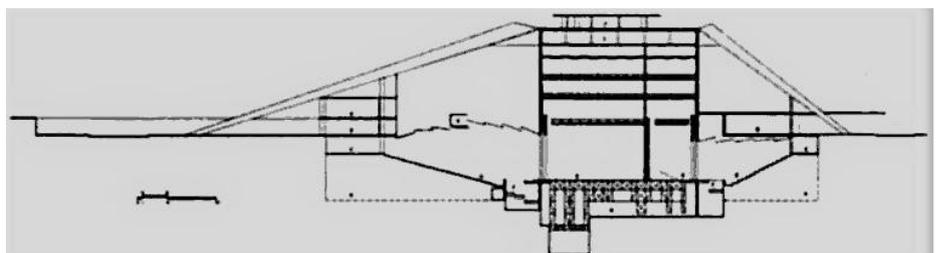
Croqui - Corte Oeste Leste do Teatro Nacional de Brasília, Niemeyer. Fonte. Revista Projeto.
